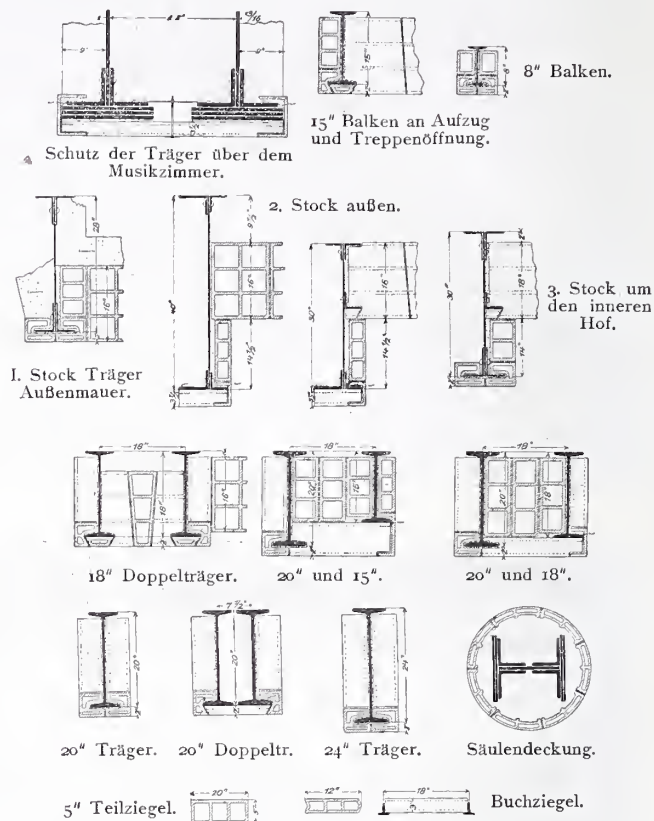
Terrakotta-Decken und Träger-Umhüllungen. Wanamaker Building in New-York.
